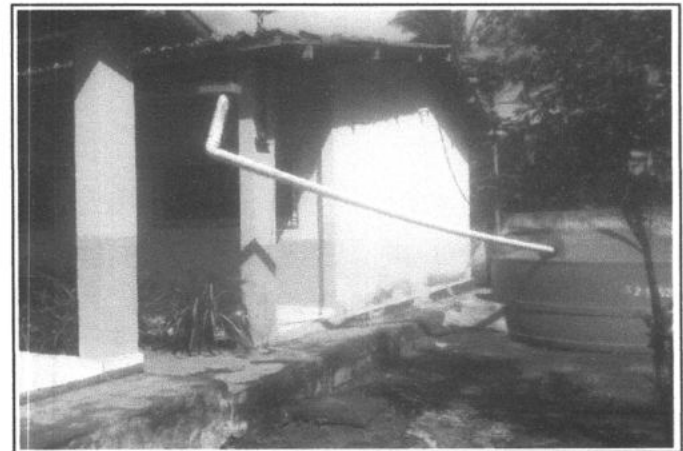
LOCAL CONSTRUÇÃO WCS
